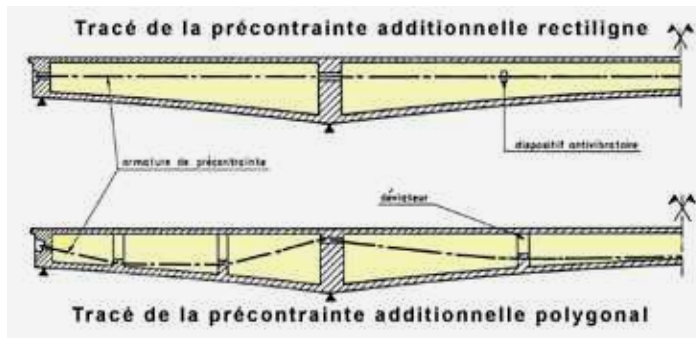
principes de renforcement d'une poutre par précontrainte additionnelle longitudinale
